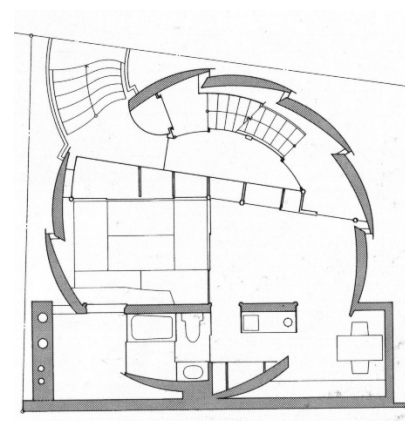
齋藤 裕 瞬居 (1997) 一階 平面図
